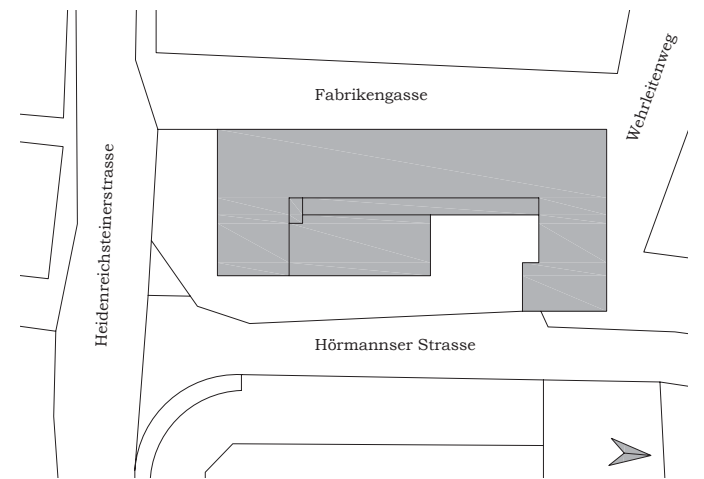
Lageplan von 2000 M 1:1000
